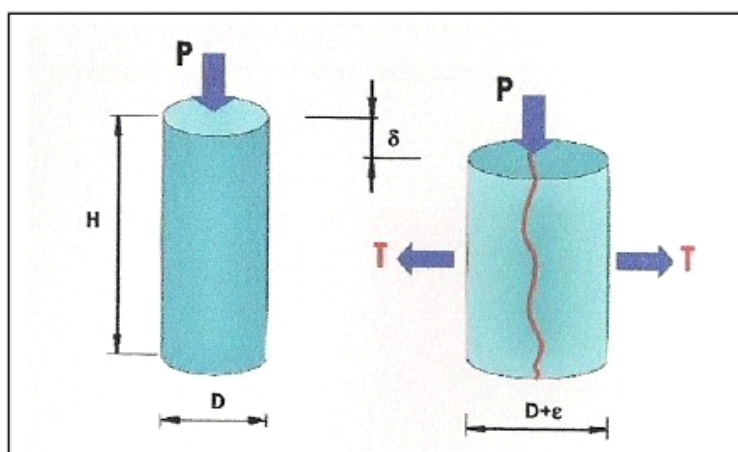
Mecanismo de formação das fissuras
